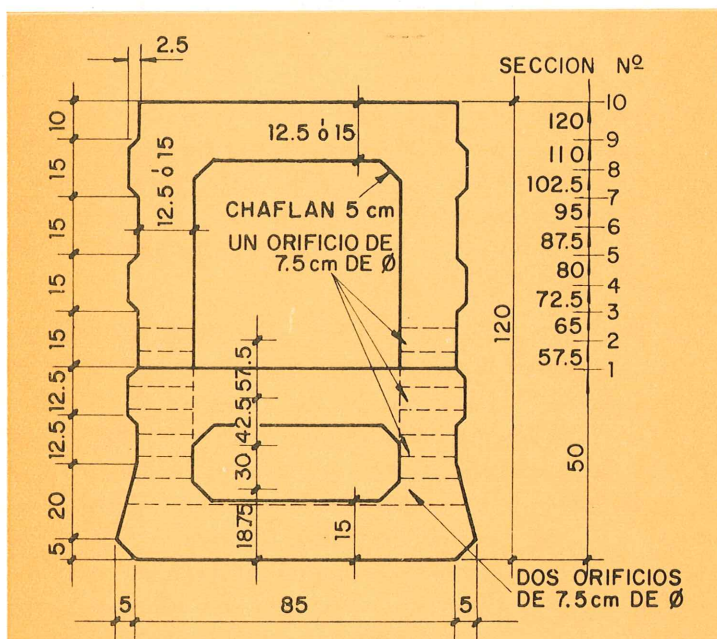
Detalle de las vigas tipificadas, de sección en cajón, números 1 a 10. Todas las dimensiones se dan en centímetros.
